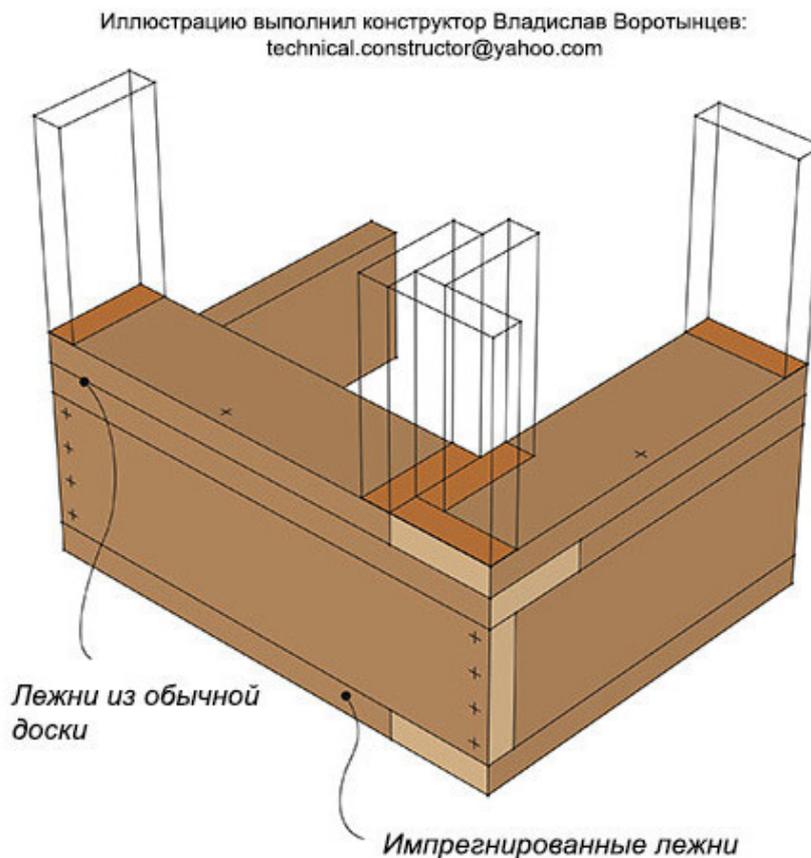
Принцип монтажа цокольного перекрытия по бетонной ленте фундамента
